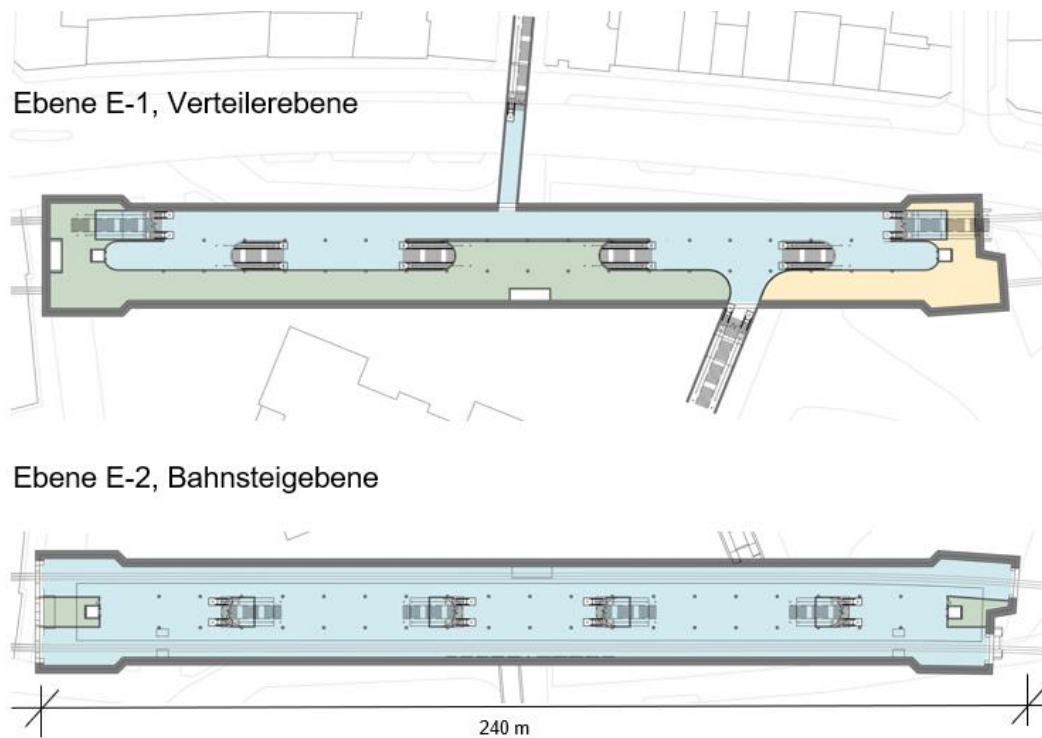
Hp Feldstraße – Grundrisse
